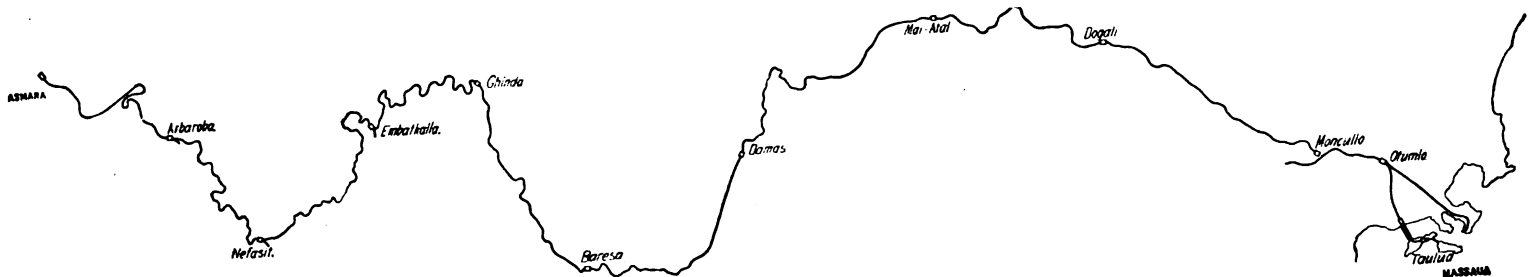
Ferrovia Massaua-Asmara. - Planimetria.
